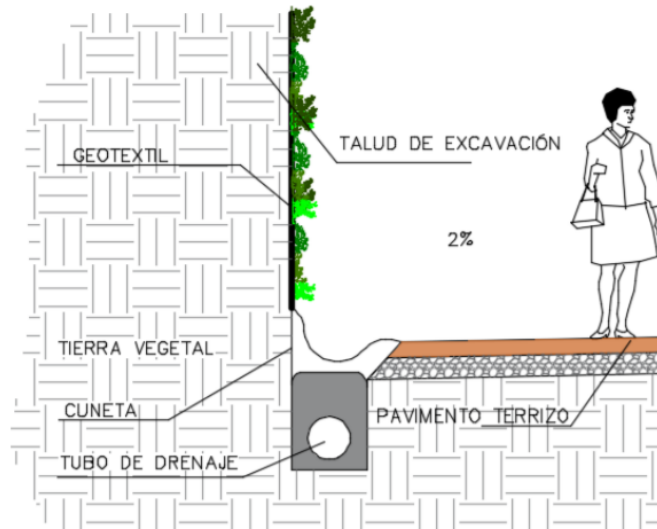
Detalle de talud Fuente: (Andrade, 2022)
